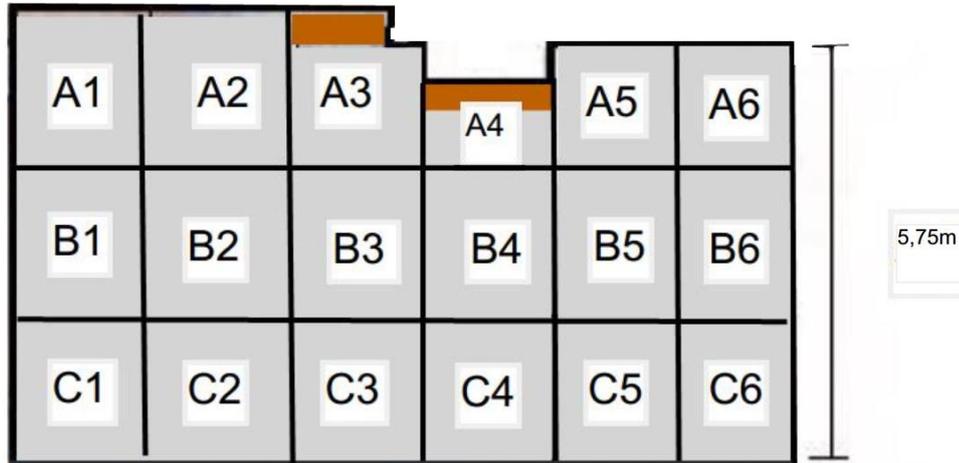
Planta baixa com indicação dos porões (numerados) e todas as áreas de intervenções subsuperficiais relacionadas às obras de drenagem pluvial e cloacal identificadas pela cor terracota
